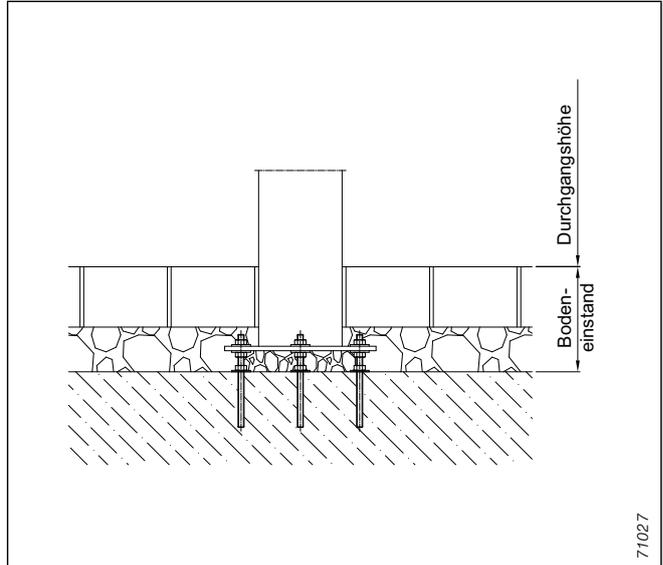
Befestigung auf Betonfundament (mit Distanz)
